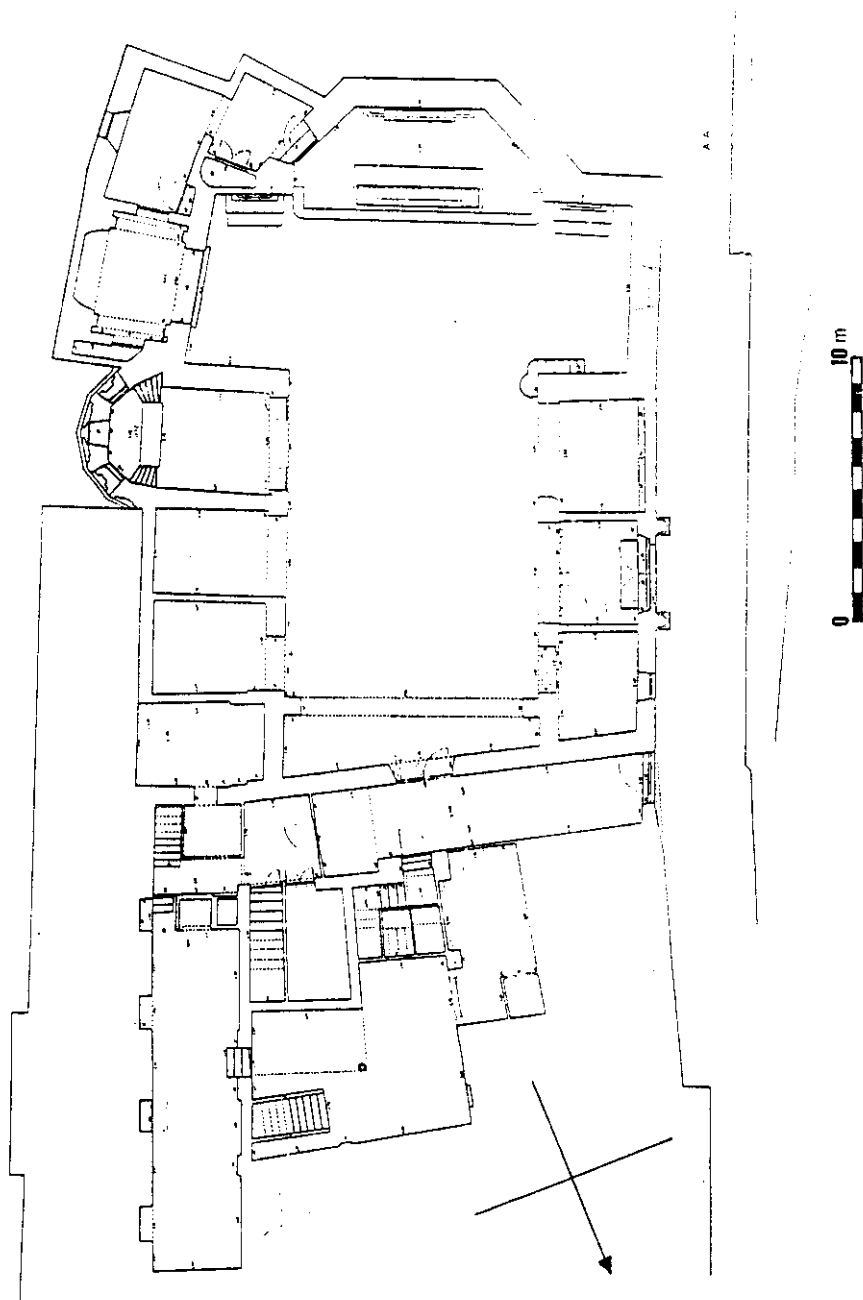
Plano en planta realizado por J. C. García Perrote.
